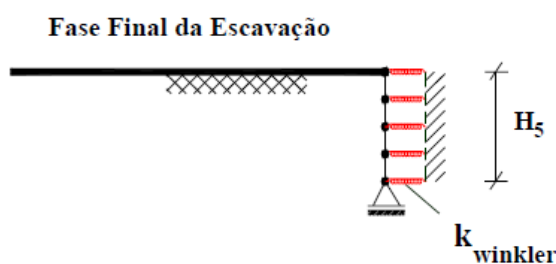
Zona k_{winkler} permanente (Sousa, et al., 2006)
